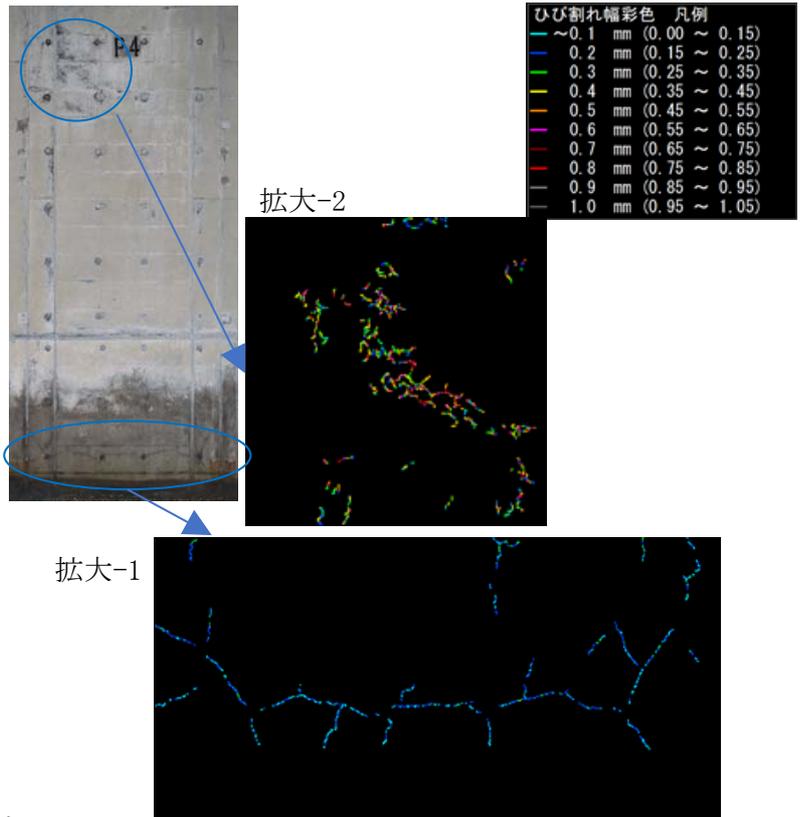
C大橋のP4橋脚の撮影画像とひび割れ図
